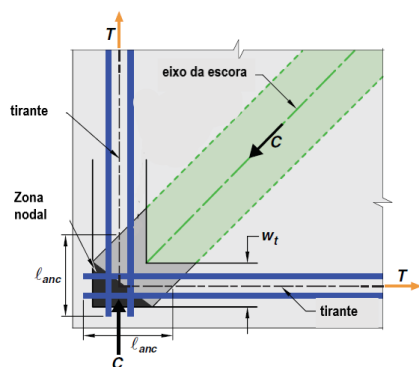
Zona nodal estendida ancorando dois tirantes em uma viga-parede. Fonte: Adaptado de (American Concrete Institute, 2019g)
